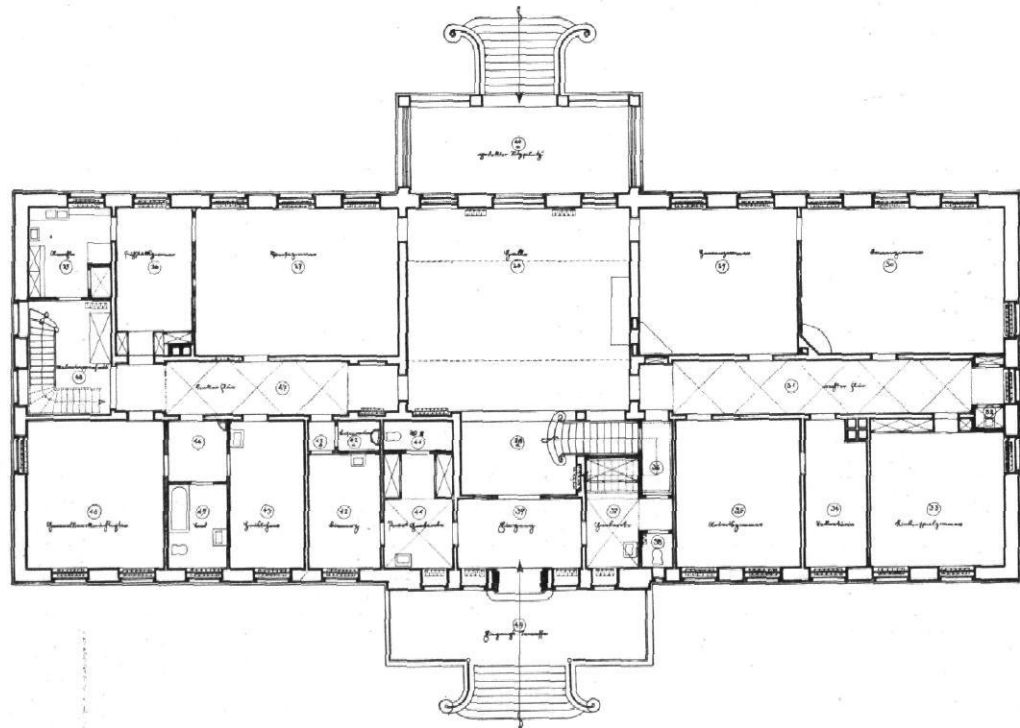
/ Herrenhaus auf Gut Alrenberg / Architekt: Otto Blendermann, Bremen / Grundriß des Erdgeschosses 1:300
